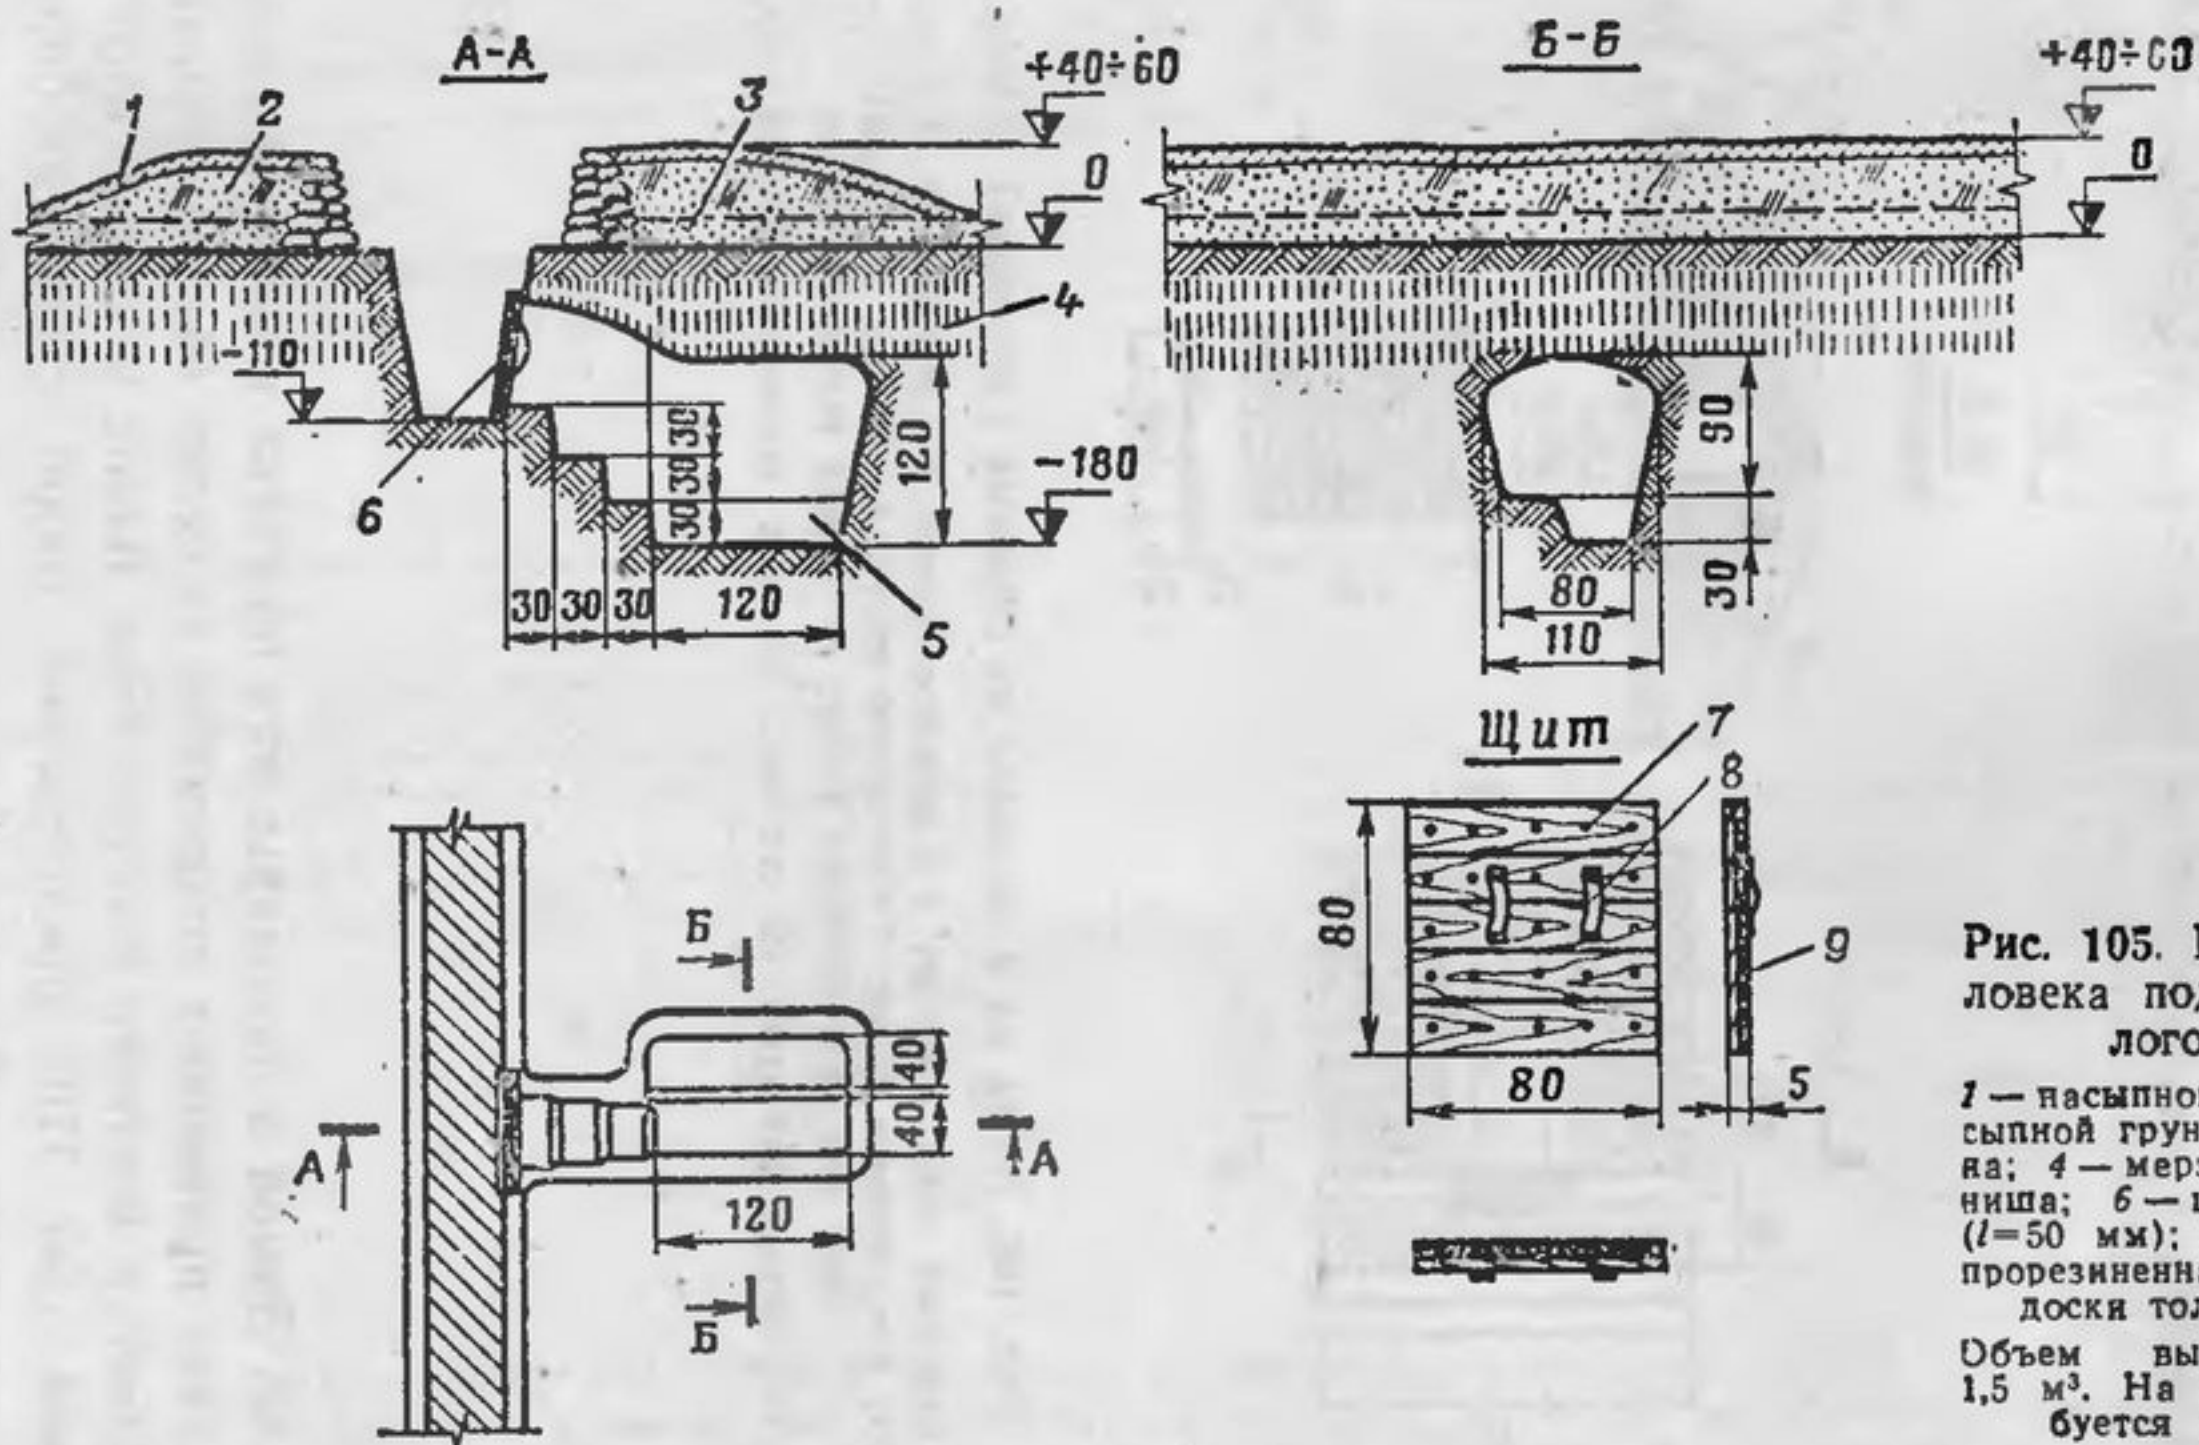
Ниша на 2 человека под слоем мерзлого грунта:
